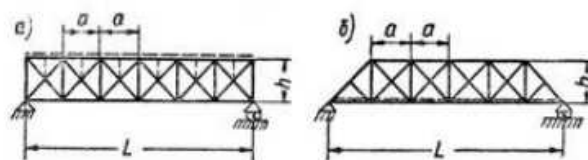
Фермы с перекрестной решеткой Д.И. Журавского
